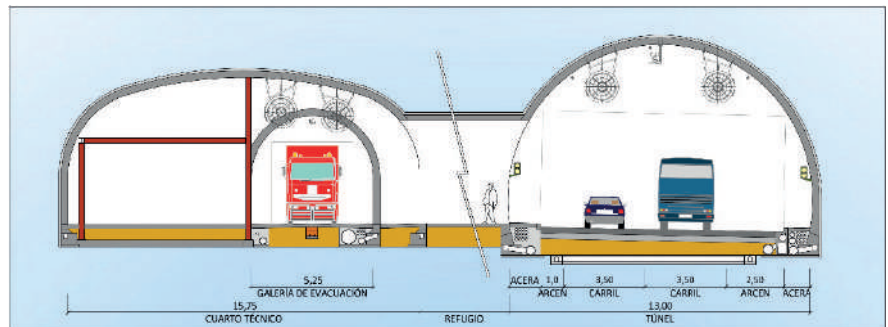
Túnel de Caldearenas. Sección tipo con galería
